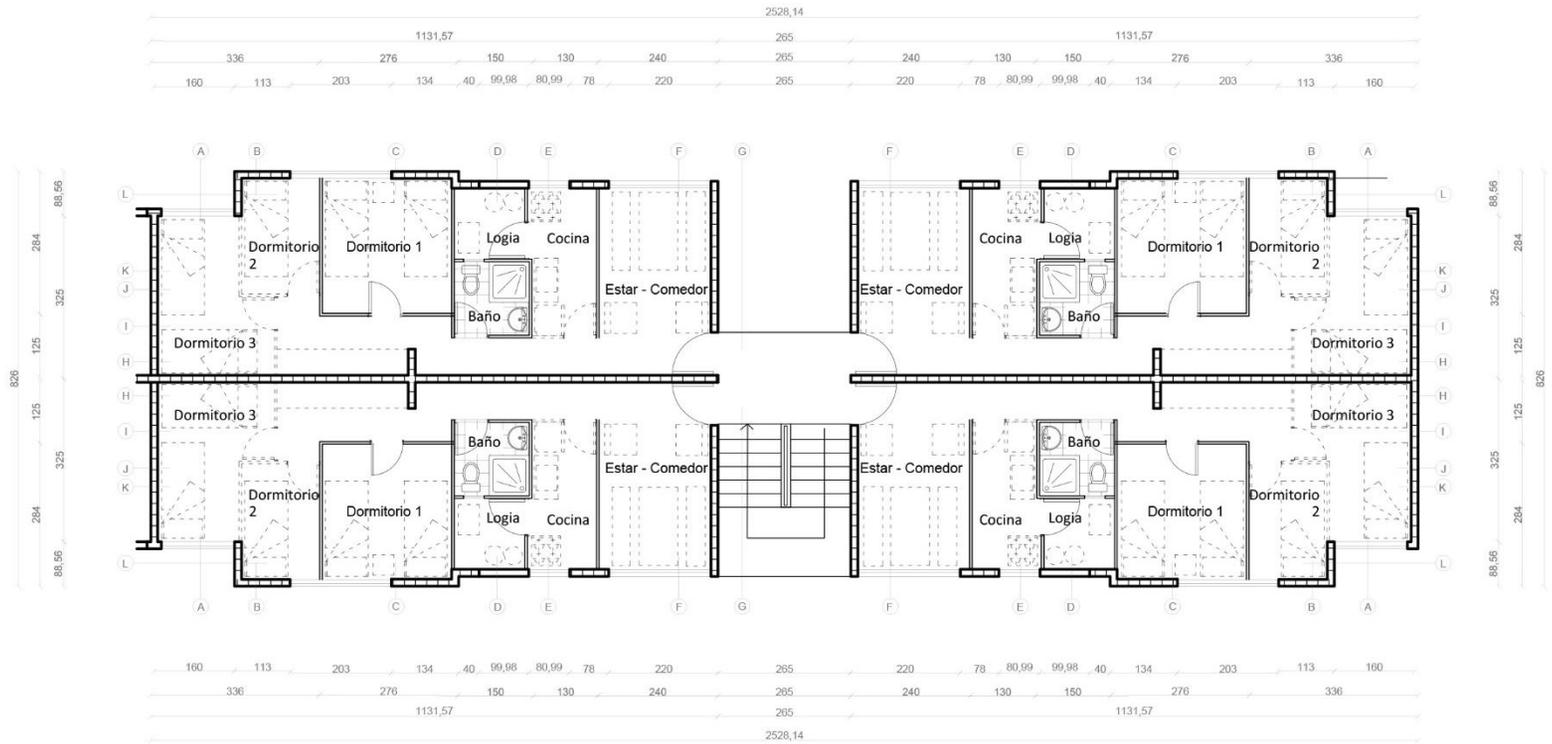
Plano tipología nº1 Marta Brunet, escala 1:150. Fuente: Elaboración propia.
